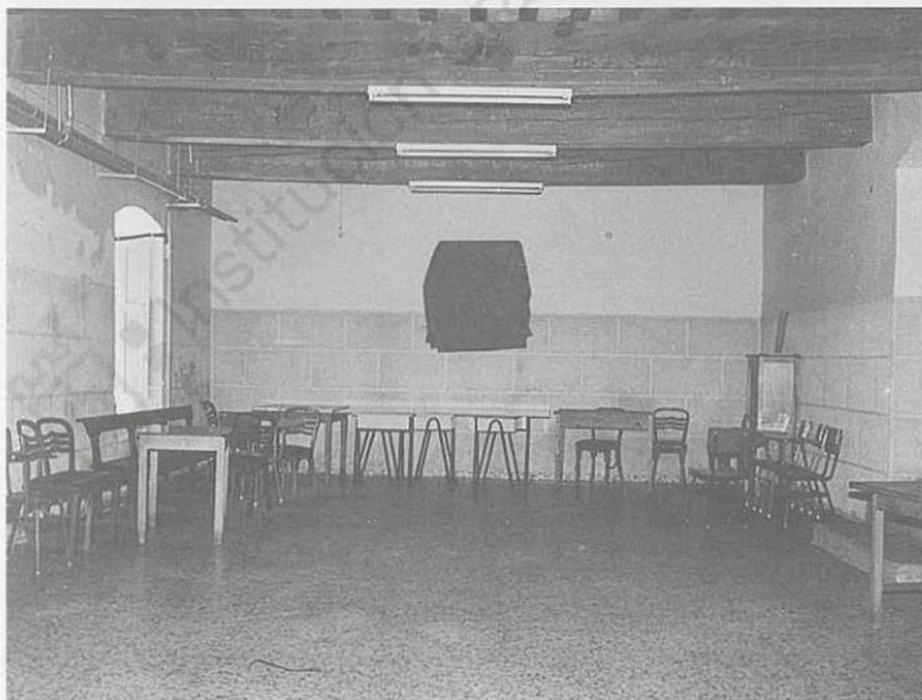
Claustro de los Reyes. Panda sur. Primer piso: Dormitorio de S. Alberto. Muro norte-lado sur. Vano nº 12. Abril 2001; curso de la restauración.
